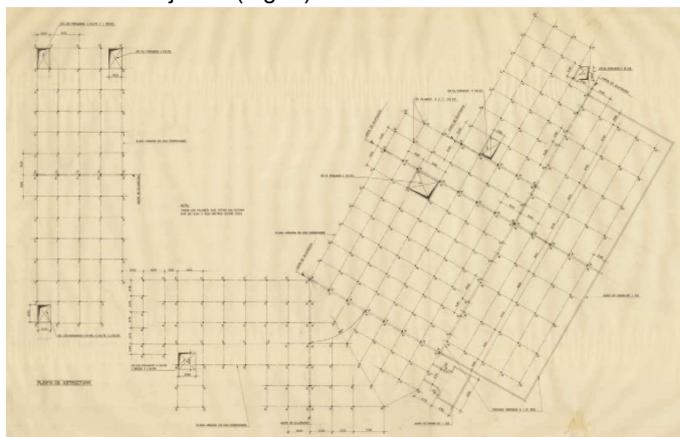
Planta modulada. En: VERDASCO, A. Archivo de Curro Inza.
